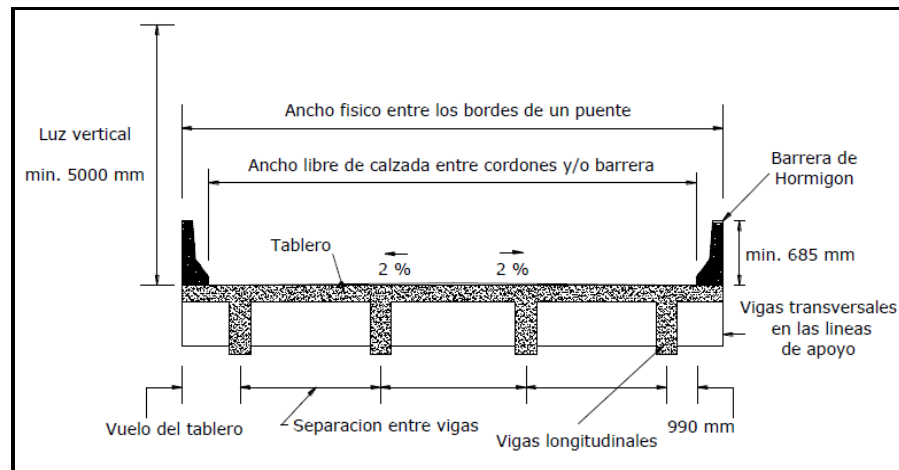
Tablero y estructura portante, puente Viga-Losa
